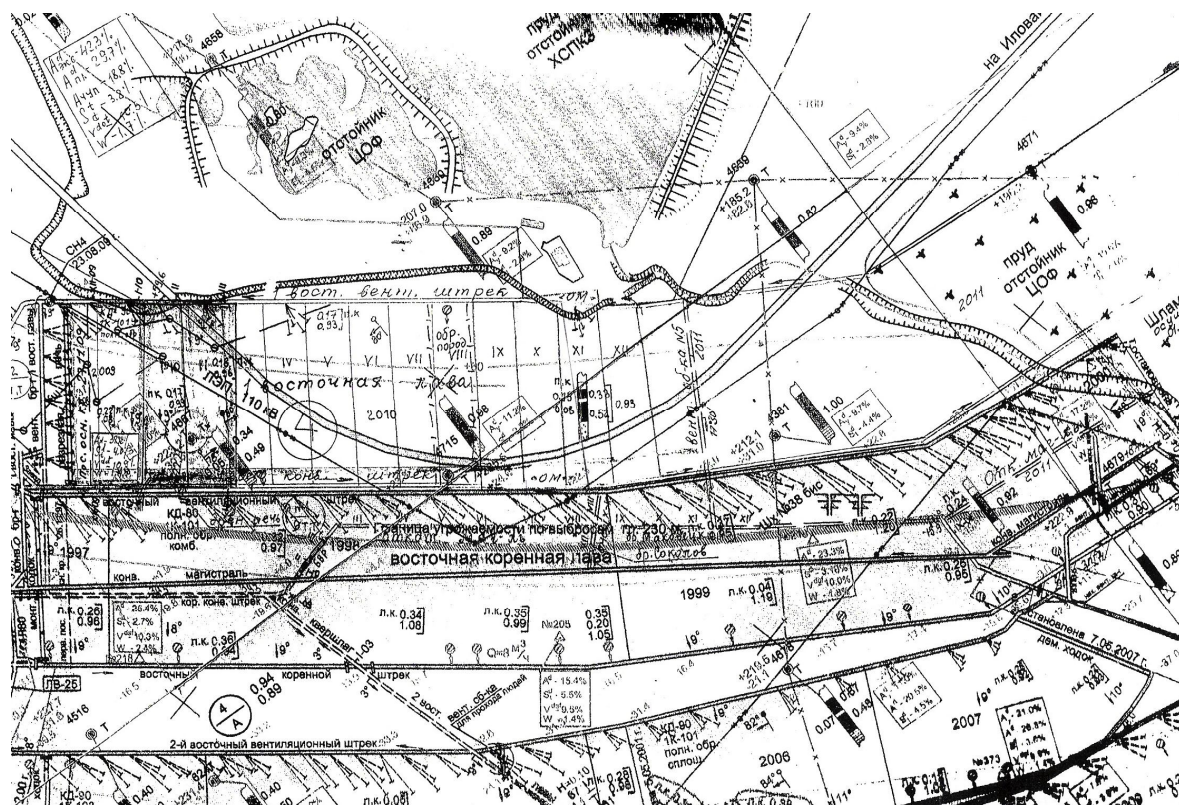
Фрагмент плана горных выработок по пласту h_{10}^B
